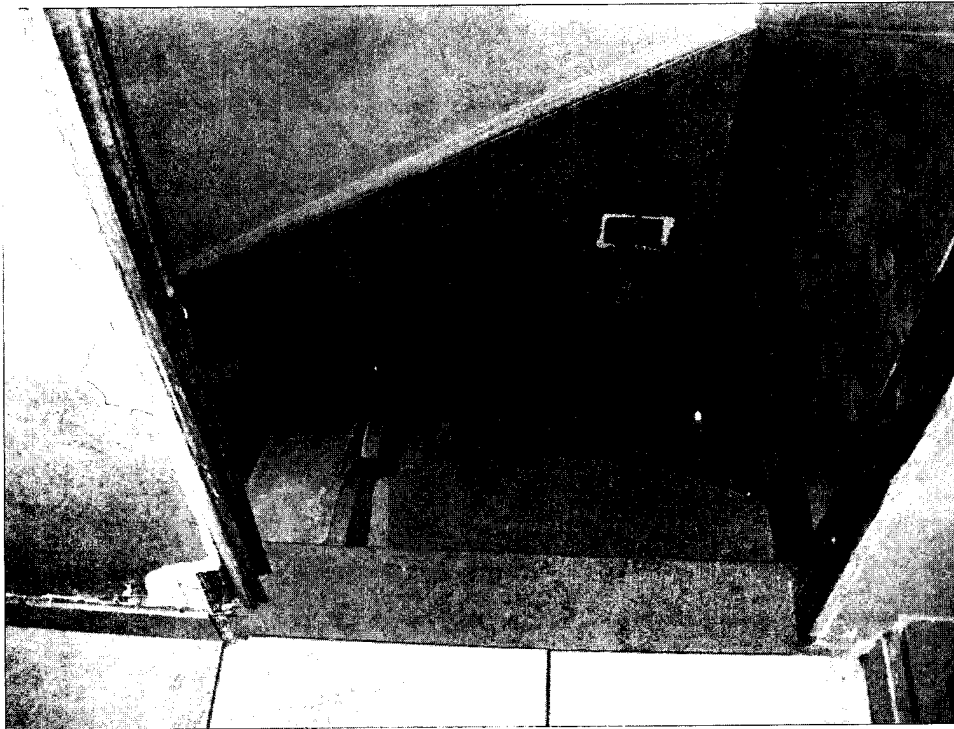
Porzione unità i. 1: scala d'accesso al piano soppalcato
